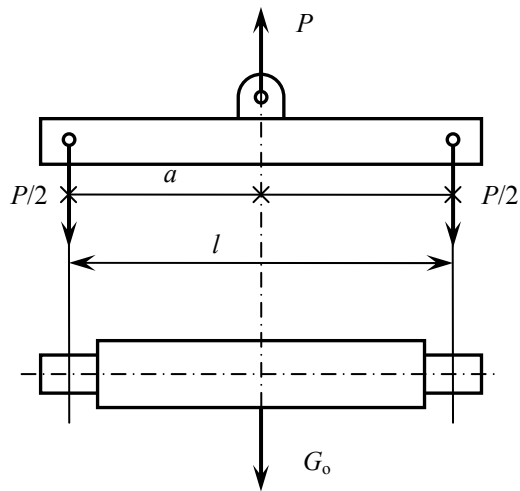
Расчётная схема траверсы, работающей на изгиб
